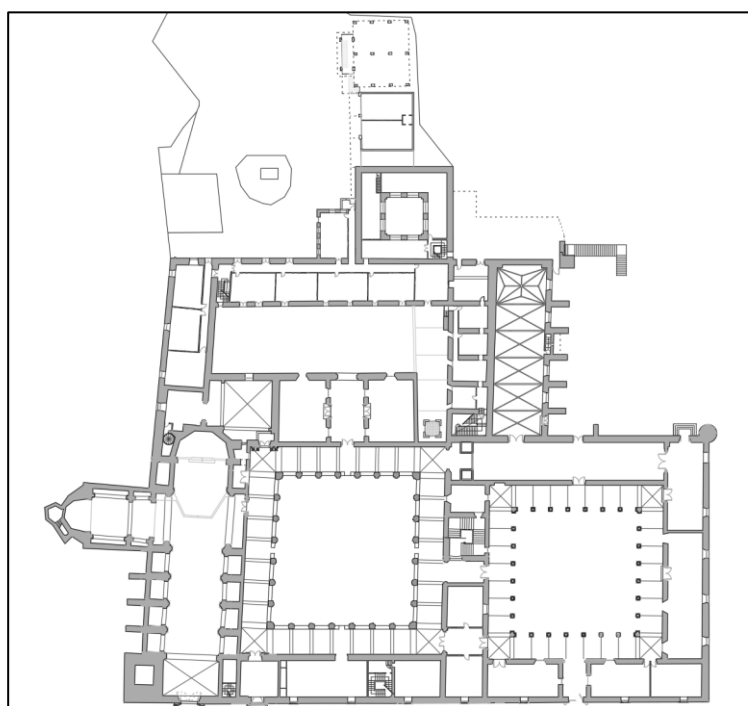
Plano de planta intermedia del Colegio BIC.
